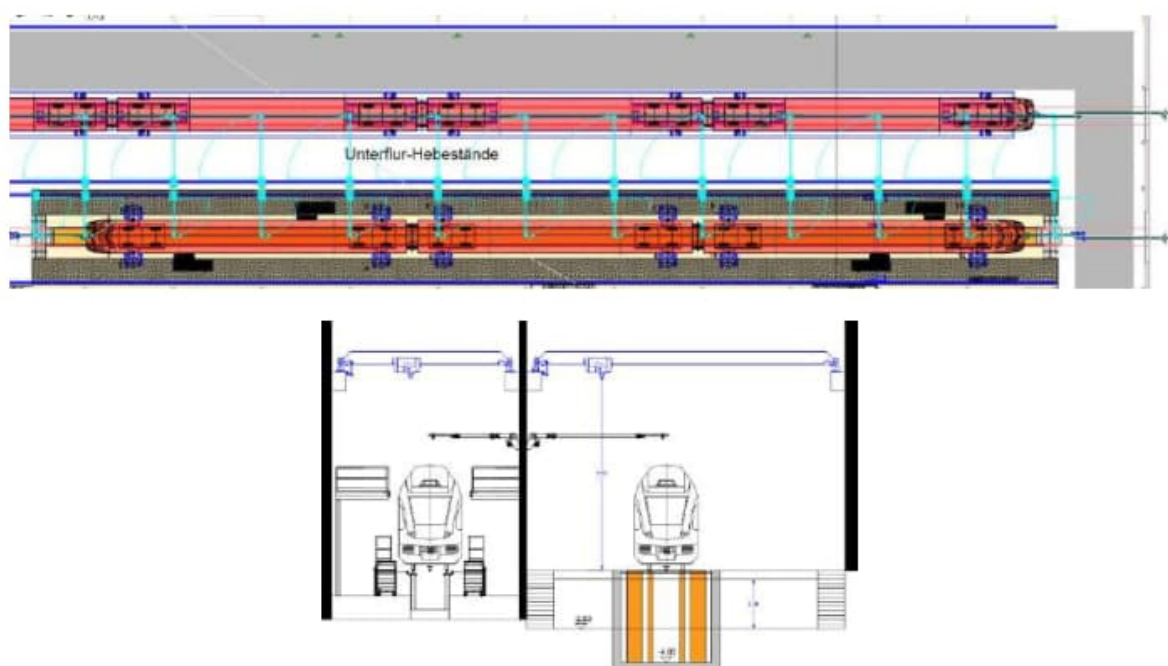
Vue en plan et en coupe des bancs et des dispositifs de levage de trains
